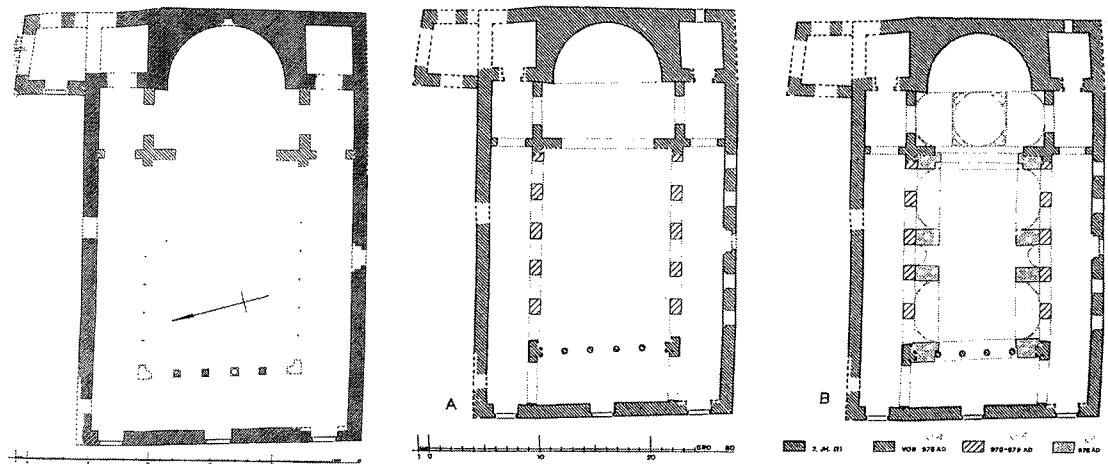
مسقط أفقي لكنيسة السيدة العذراء الدمشقية.
